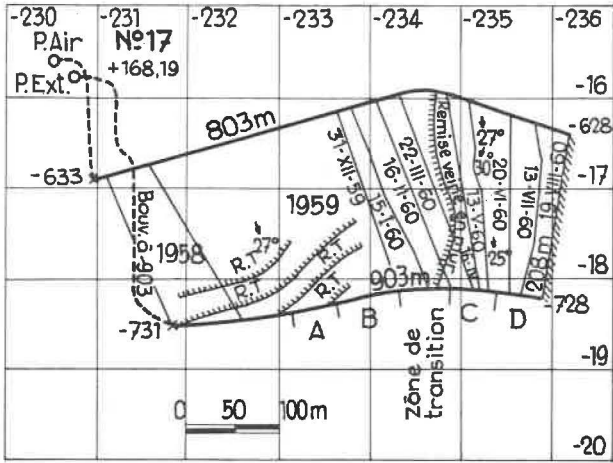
Plan du chantier de Grosse-Fosse 903 m - 803 m.
